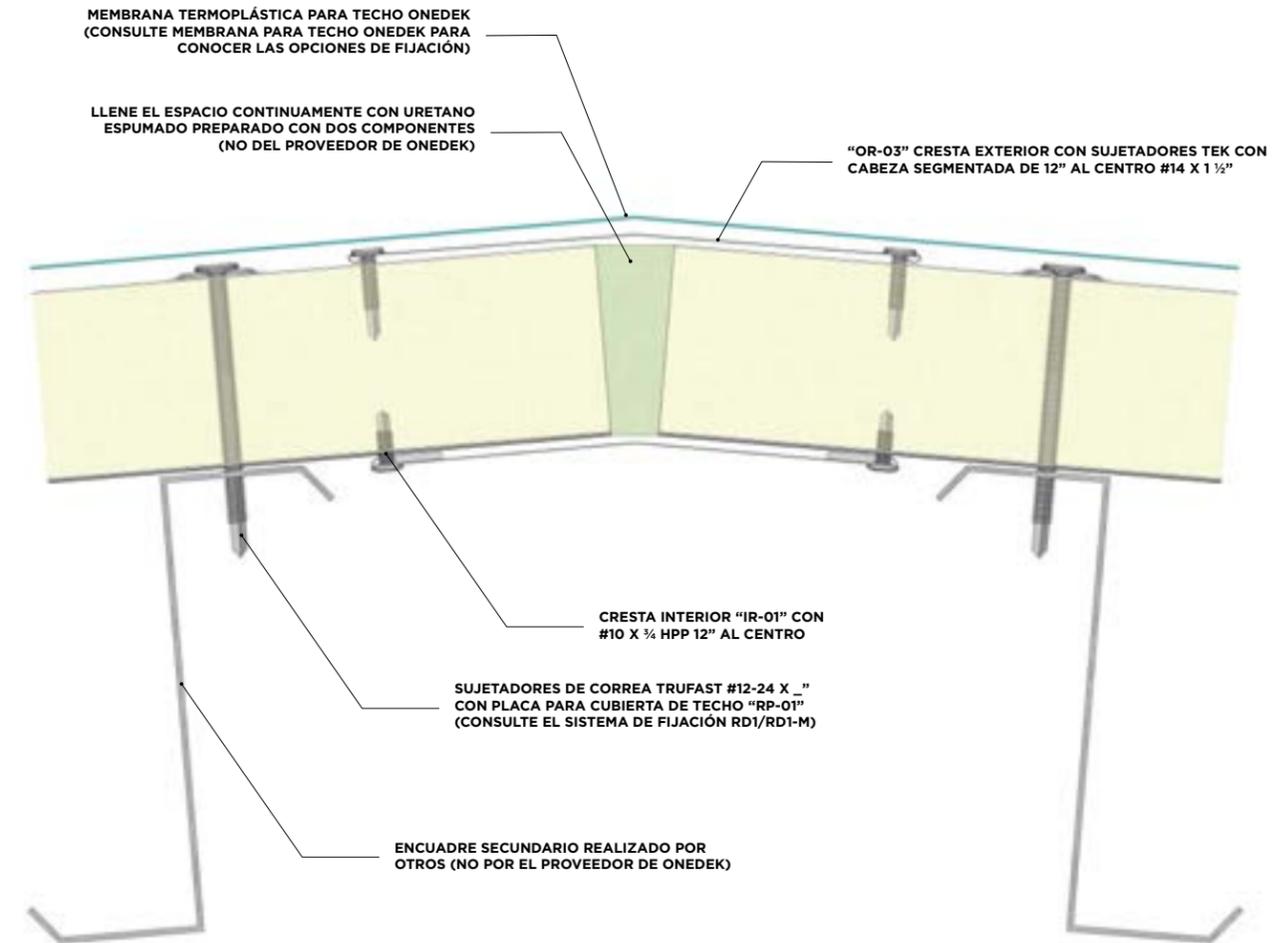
VÉRTICE DE LA CRESTA (VISTA DE LA SECCIÓN)
